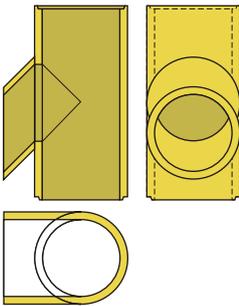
Grundriss und Schnitt Feuerstättenanschluss
